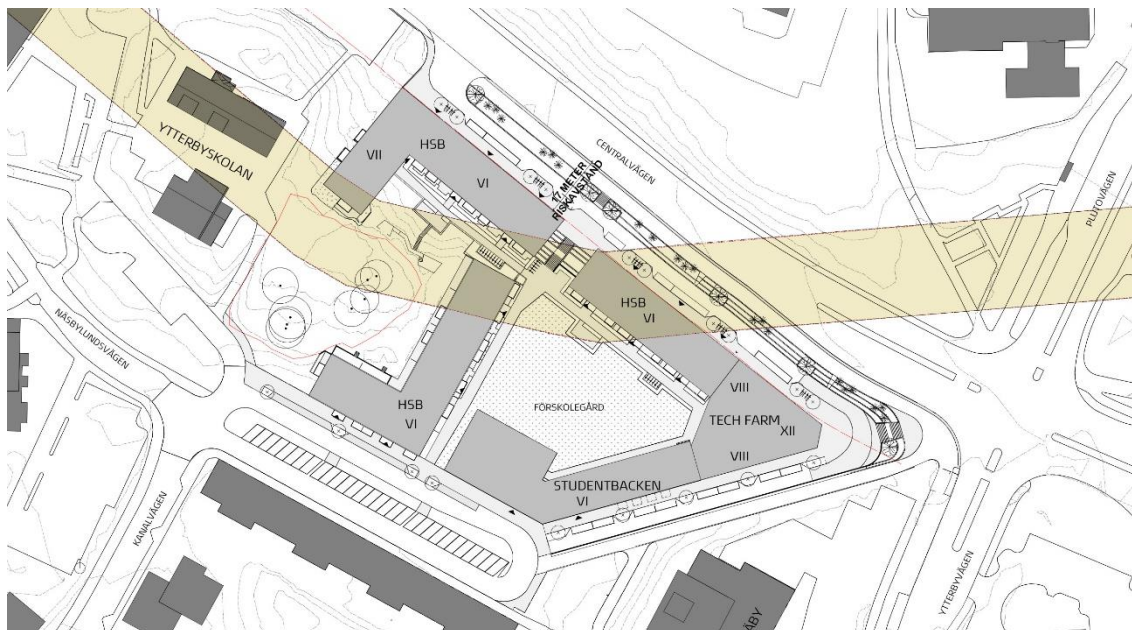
Illustration av dagvattentunnels sträckning under planområdet. Gul markering avser tunnelns skyddszon.
